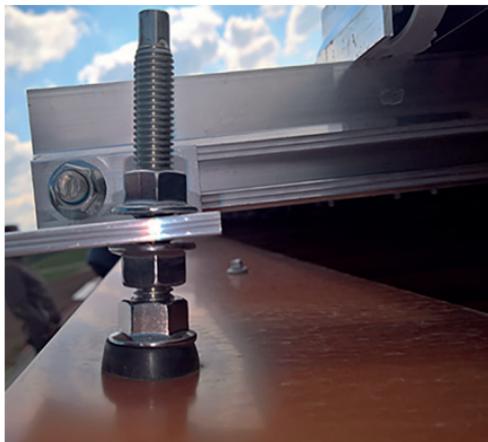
Nicht fachgerecht befestigte Stockschraube
